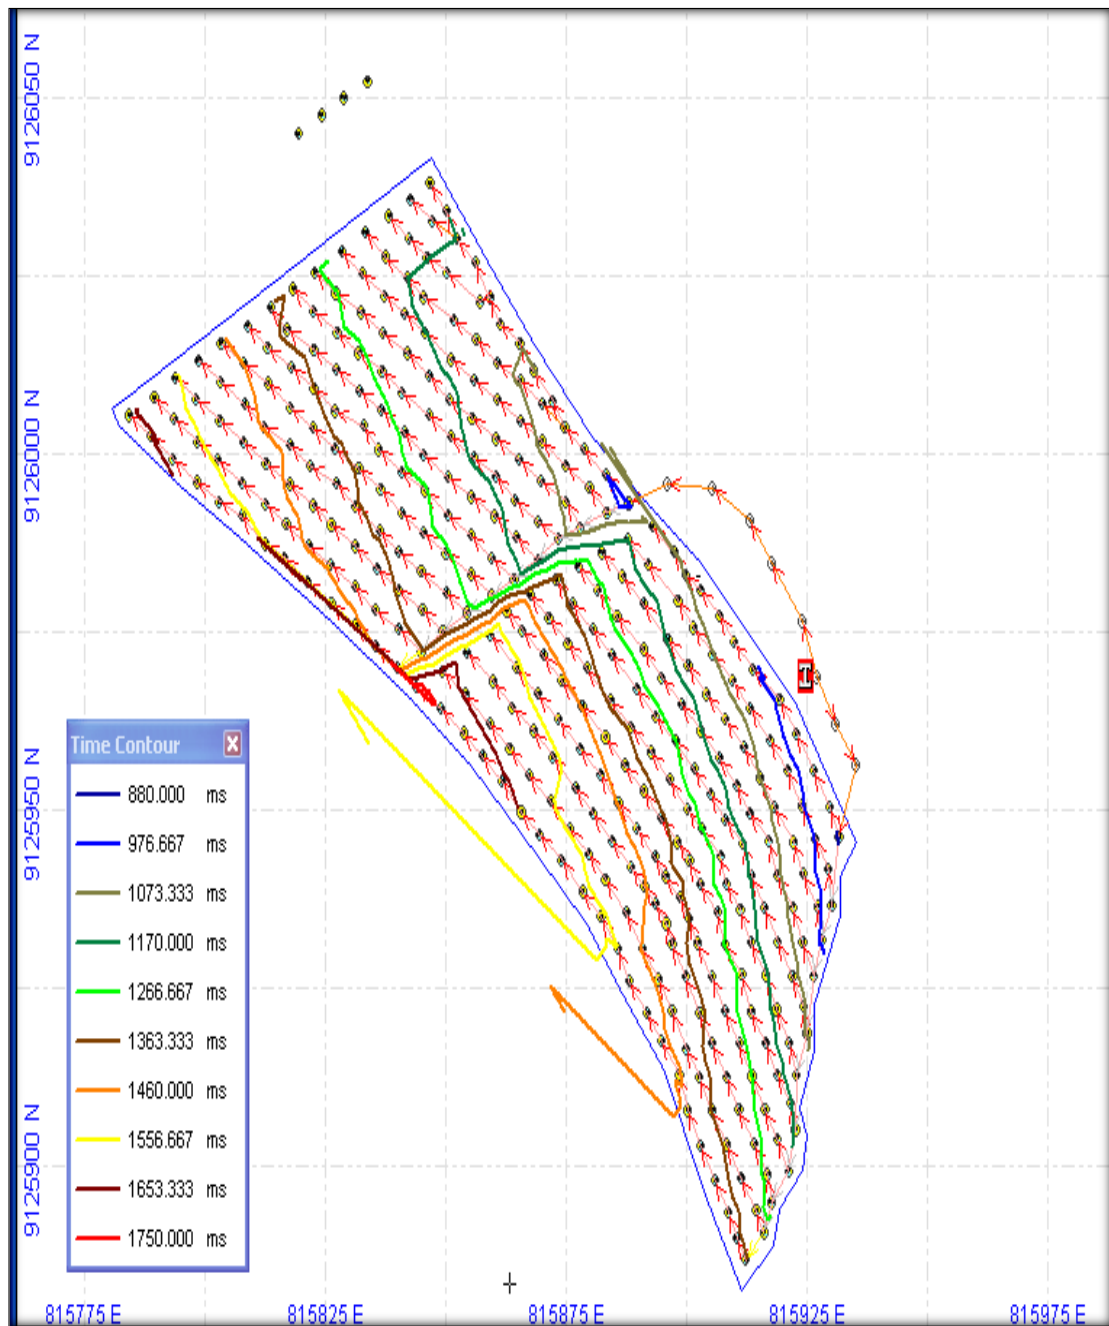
,8 Plano de Amarre de Proyecto de Voladura -Proyecto N° 197 (21-12-2013)
